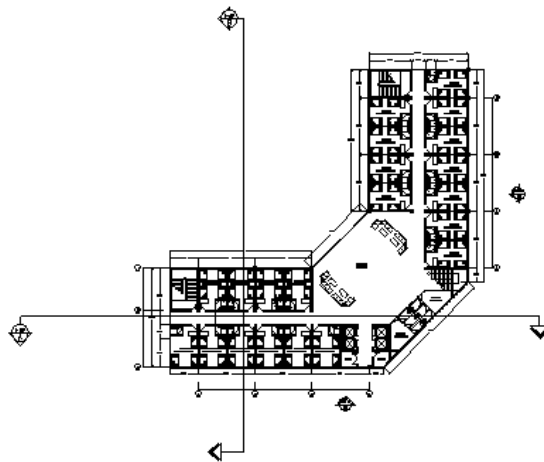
Denah Lantai Tipikal Gedung B
